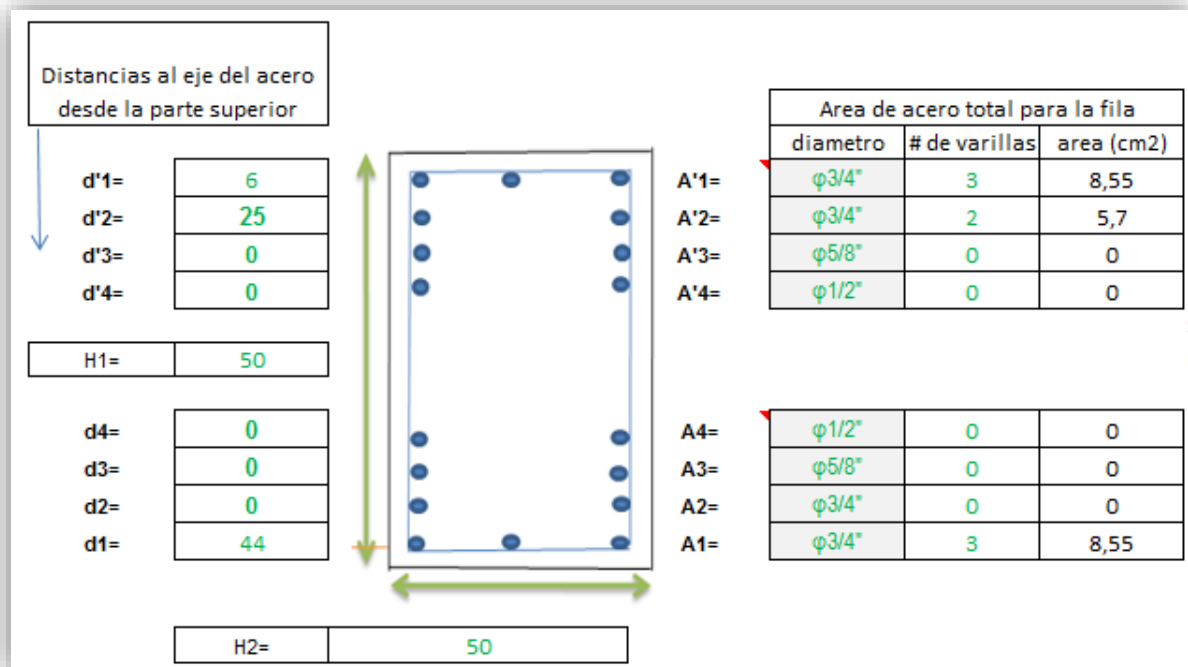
Acero de refuerzo en columna esquinera
